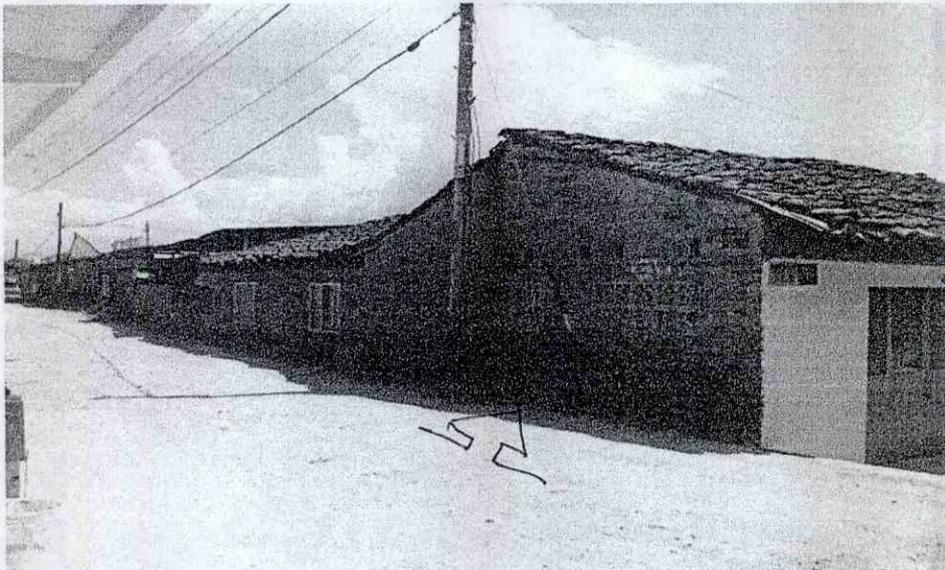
FACHADA DEL INMUEBLE SOBRE LA CARRERA 3 (AVENIDA PASTRANA)
